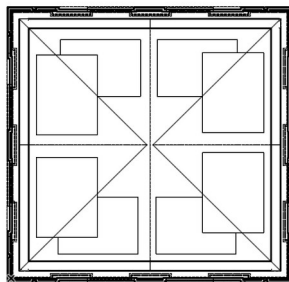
Zamosc_Grundriss_Dachaufsicht.png
